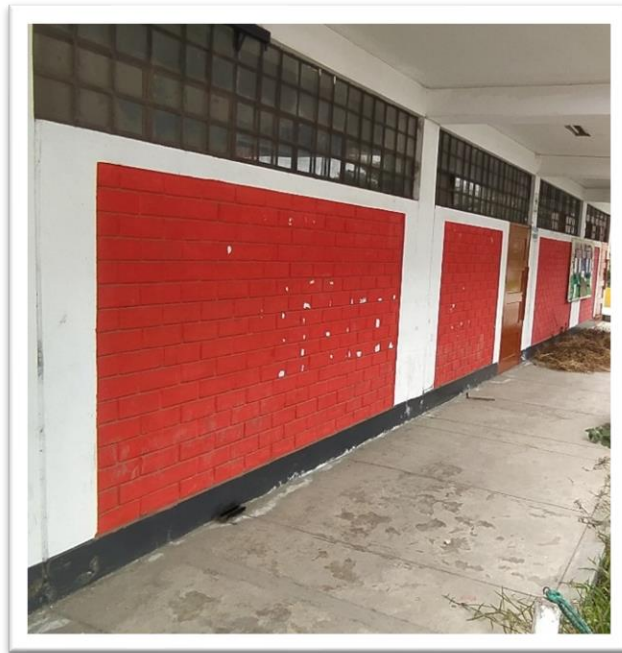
Detalles de aberturas de ventanas en el frontis del pabellón 11 – bloques A y B.
